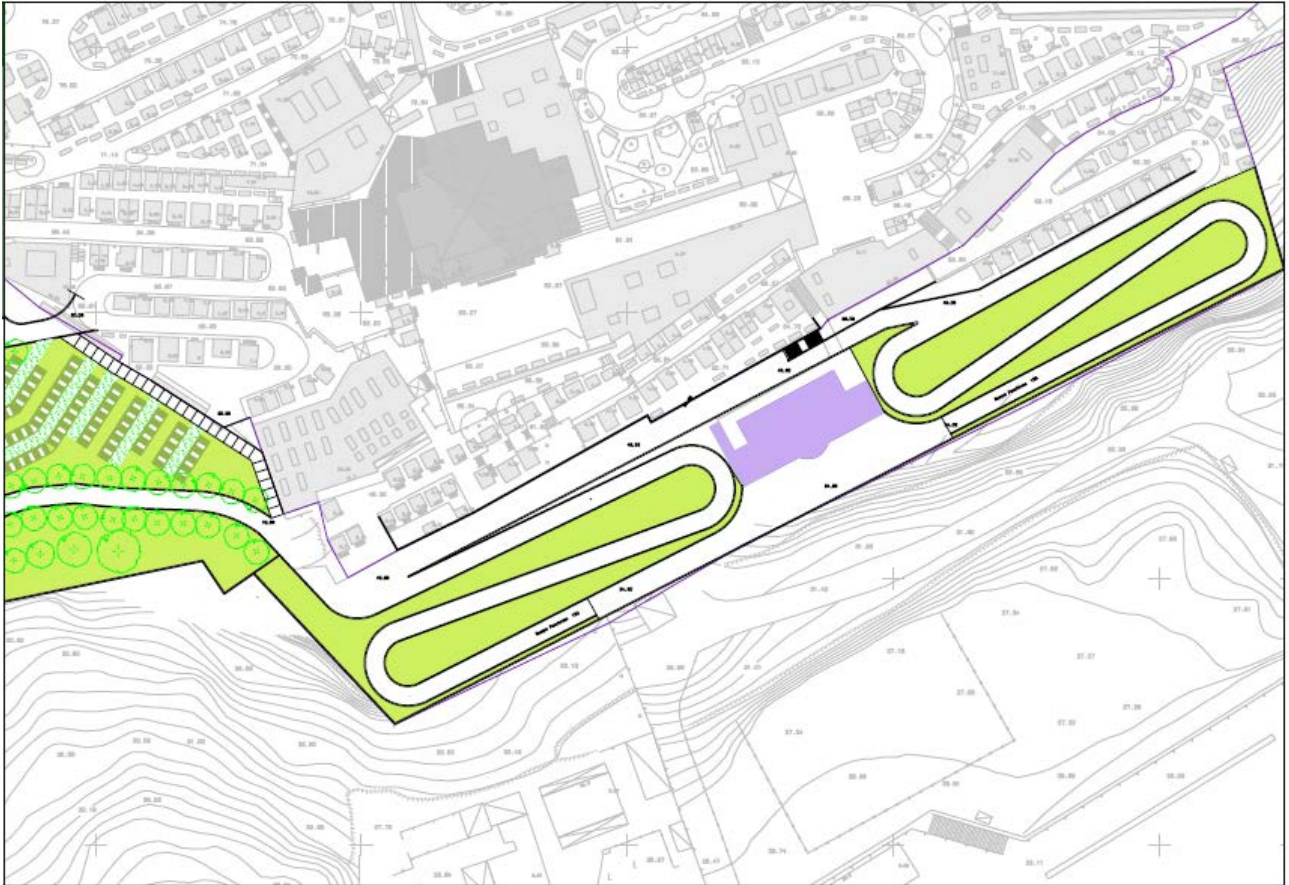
Progetto Preliminare - Pianta Area tra di collegamento tra ex colerici e Santa Maria del pianto Elaborato PR_AR_004.03
